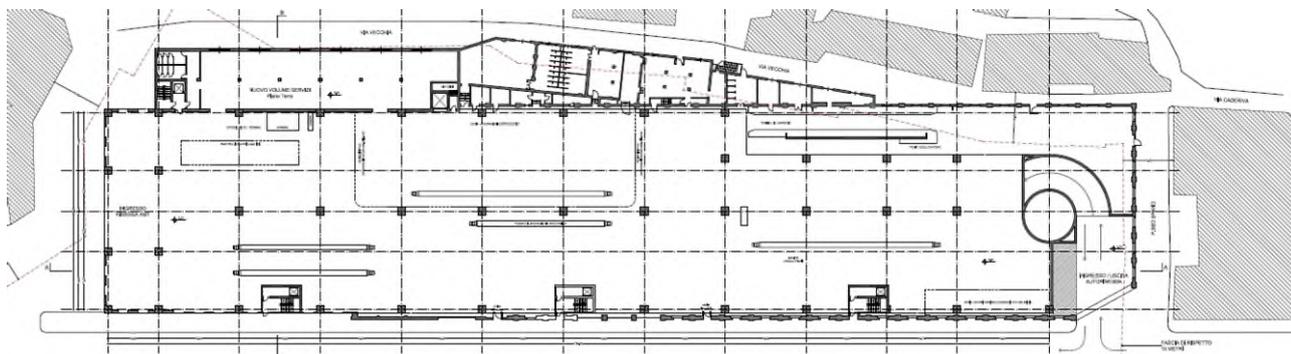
Estratto planimetria di progetto rimessa Staglieno
